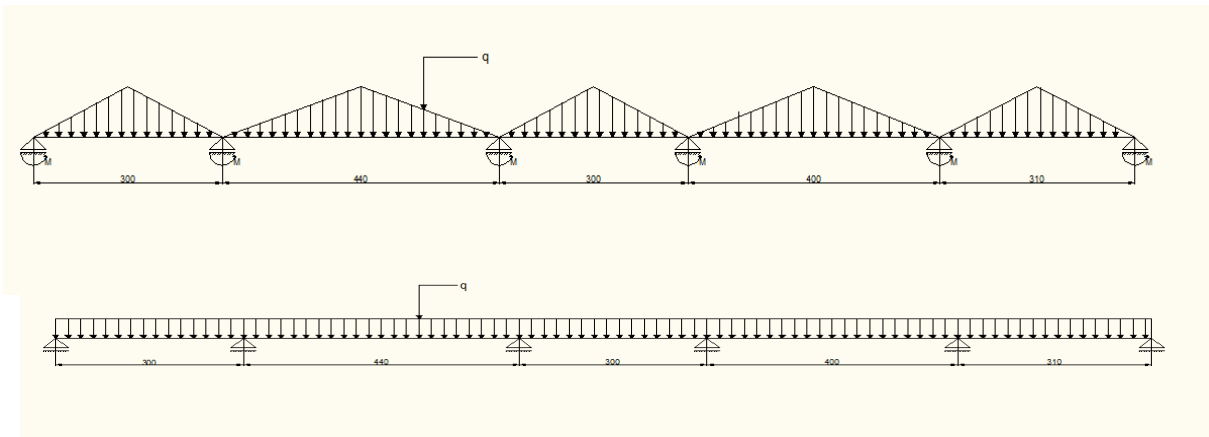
Distribution des charges sur les poutres secondaires.
